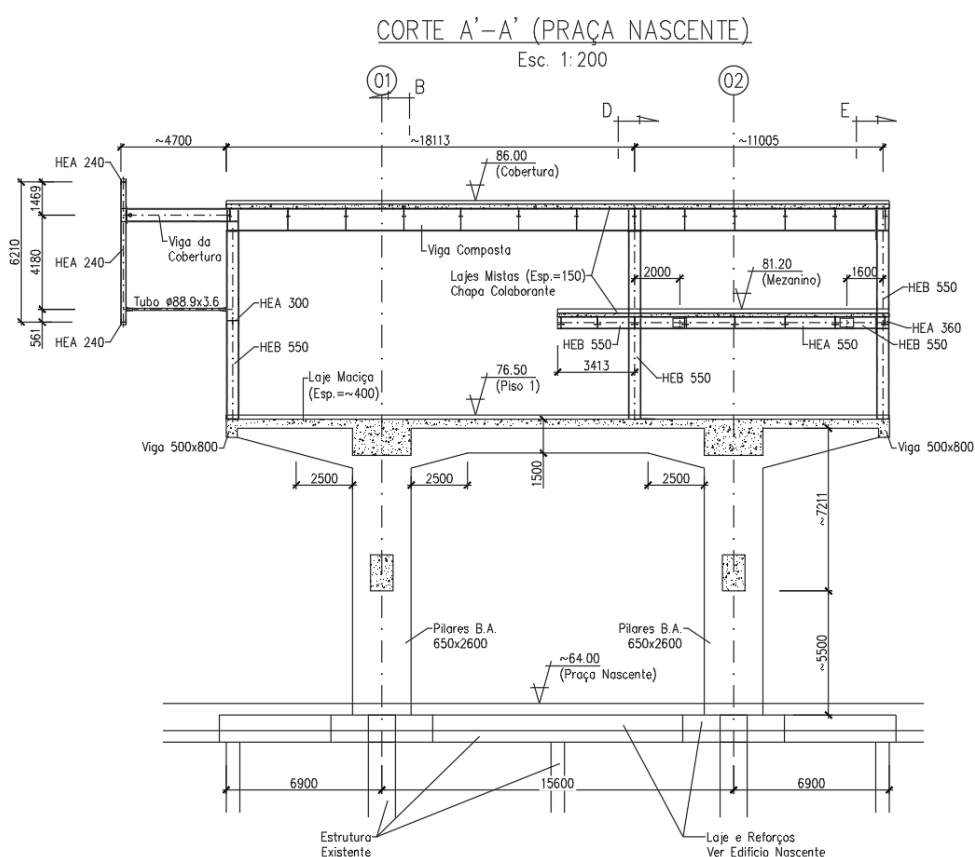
Edifício Ponte: Corte transversal praça nascente.
